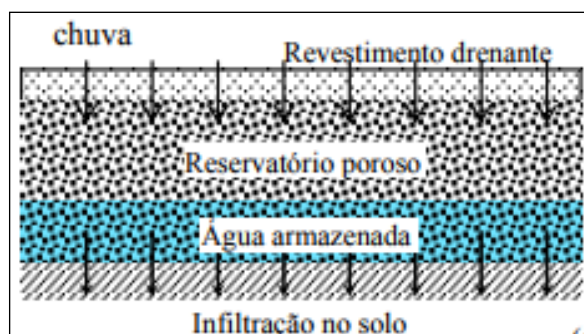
Desenho esquemático de pavimento drenante com saída da água por infiltração.
